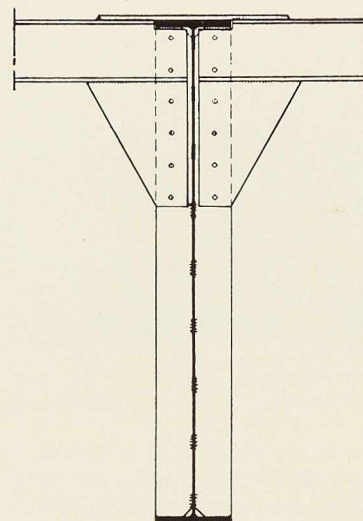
Assemblage d'une panne à la charpente de la toiture du hall.
